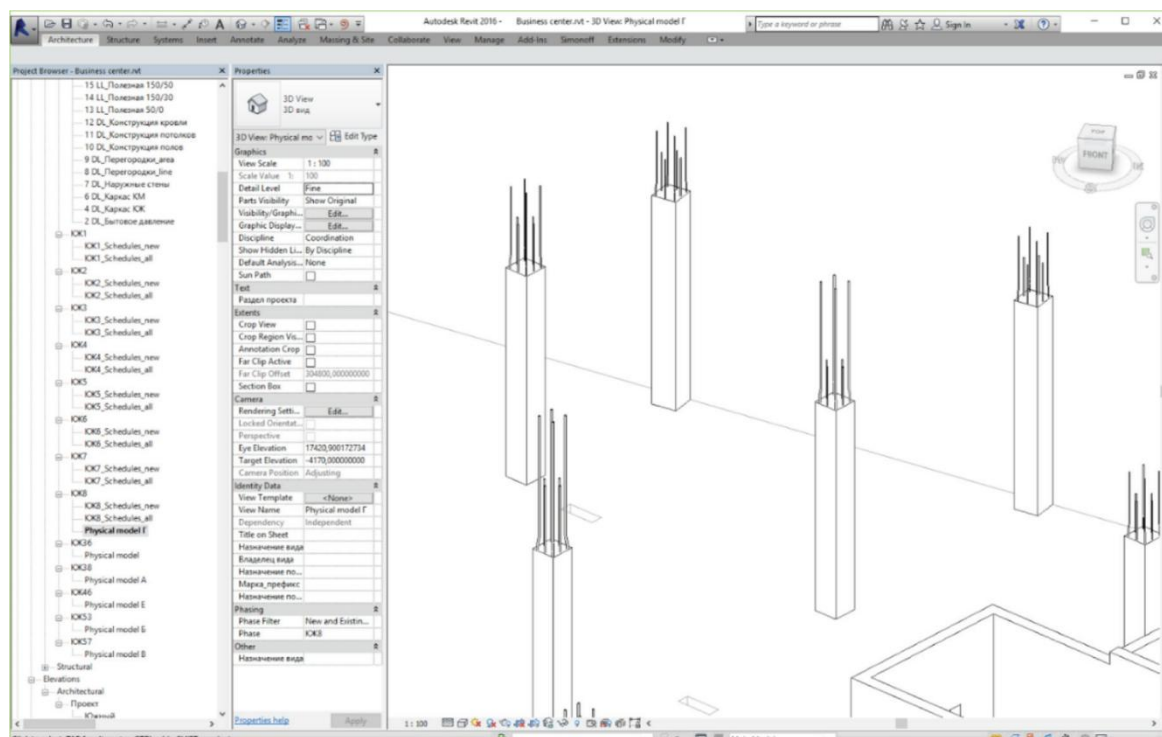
Армирование колонн с использованием Dynamo + Revit
